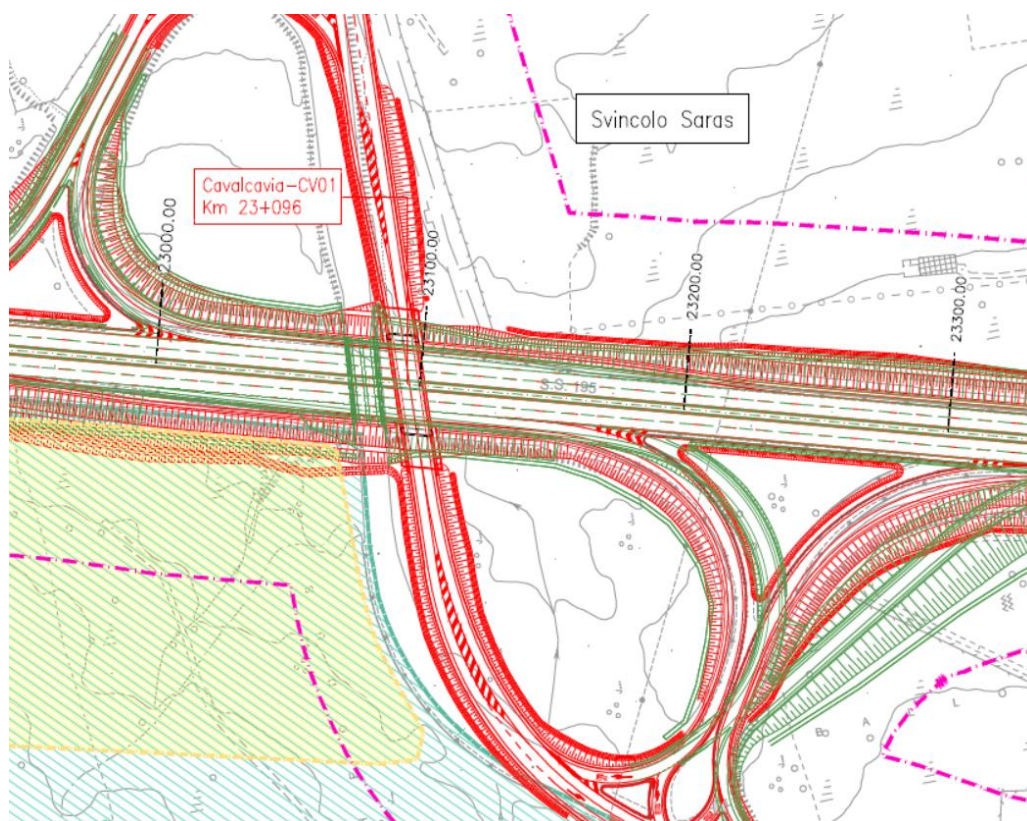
Stralcio sovrapposizione planimetrica posizione cavalcavia svincolo SARAS
